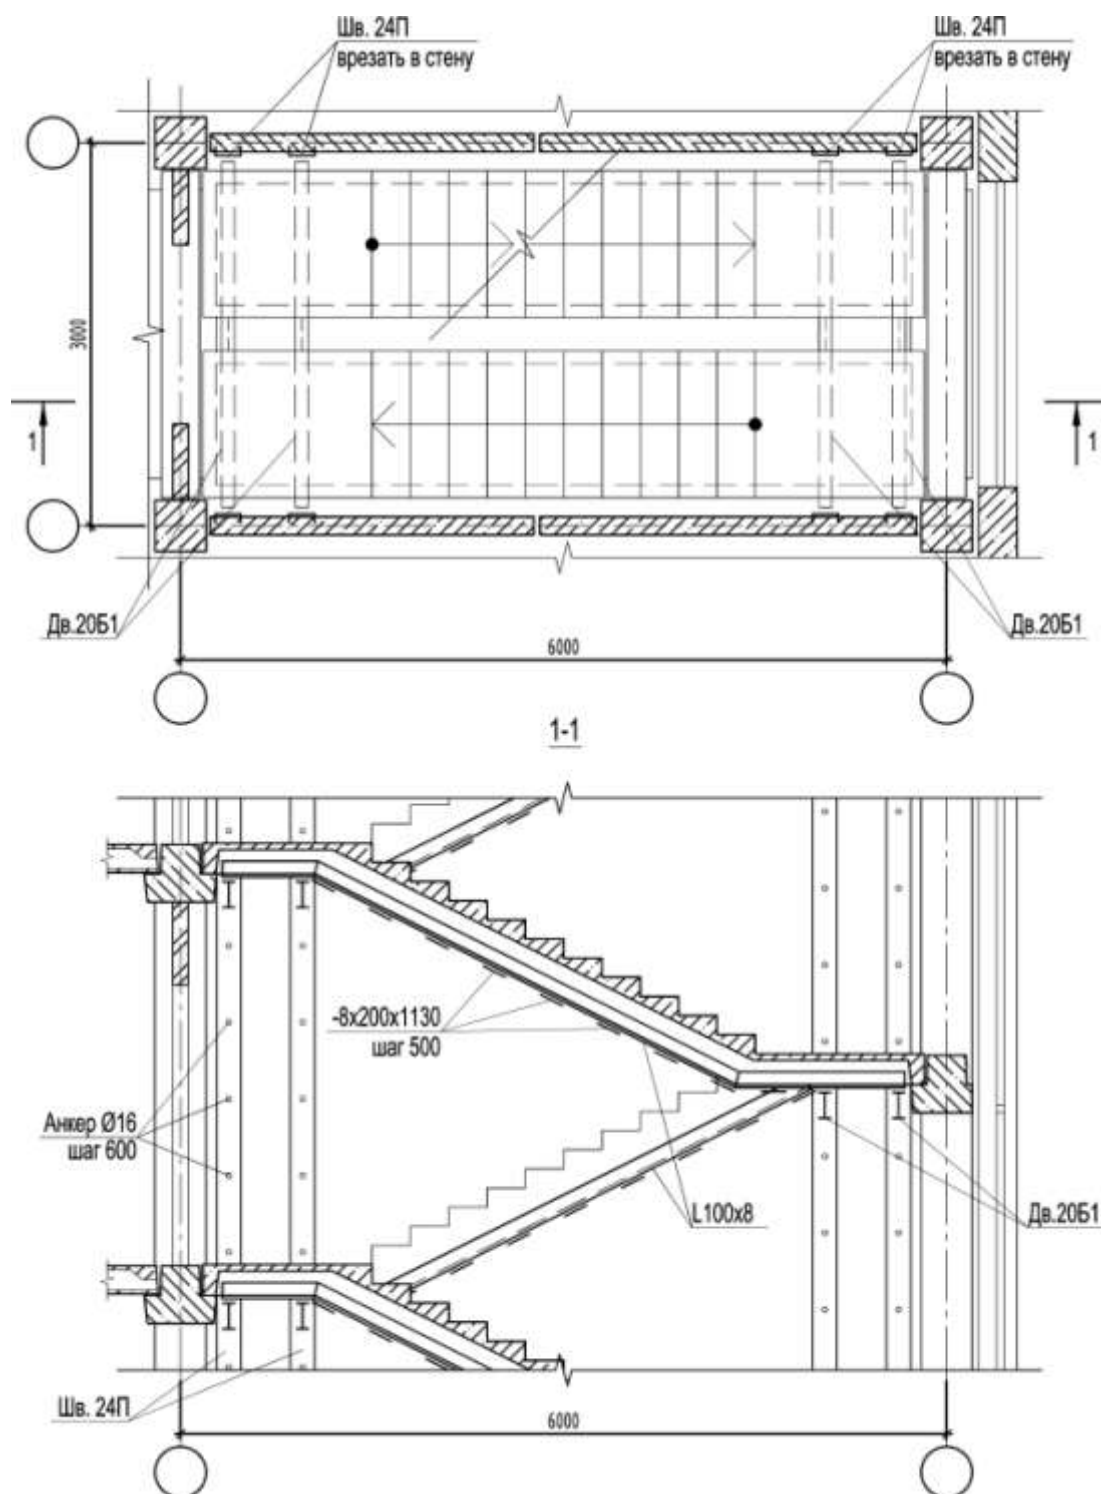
Схема стального каркаса внутри лестничной клетки, предотвращающего обрушение маршей лестницы
